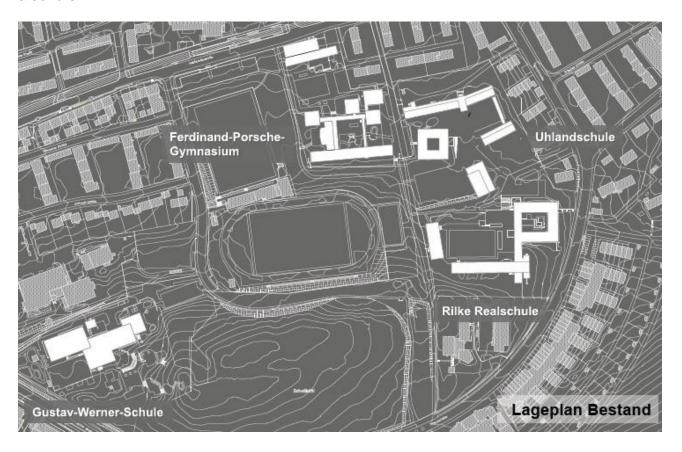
Lageplan des Schulzentrums in Stuttgart-Rot
